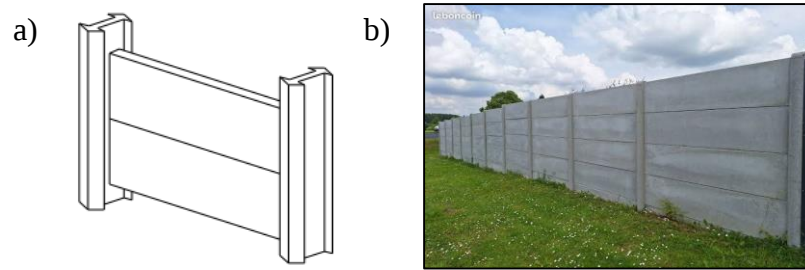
Poteaux et plaques béton [NF EN 14475]
